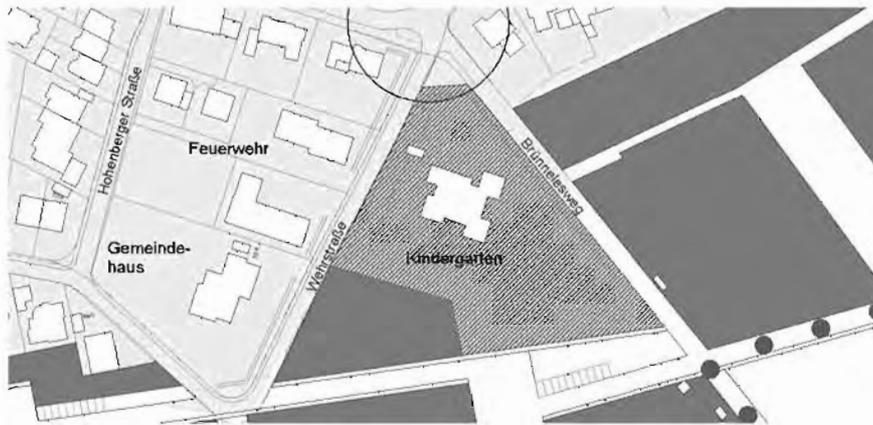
Kindergarten- und Freiflächenerweiterung, Planausschnitt
